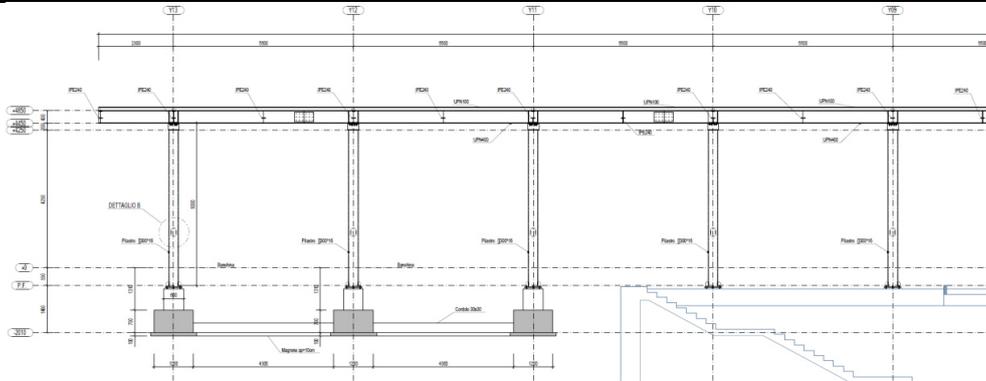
Pensiline - Stralcio sezione longitudinale Pensilina Sud
